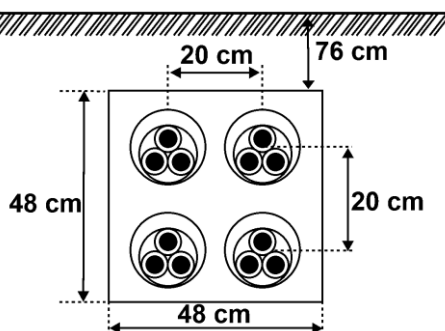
Exemplo de um cabo instalado dentro de tubagens enterradas no solo
